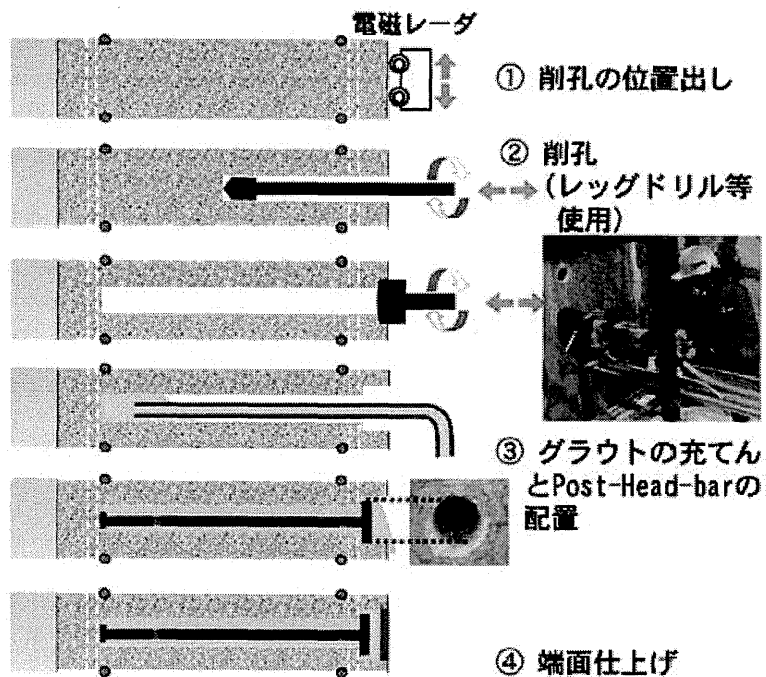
後施工鉄筋補強筋工法による補強概要図
